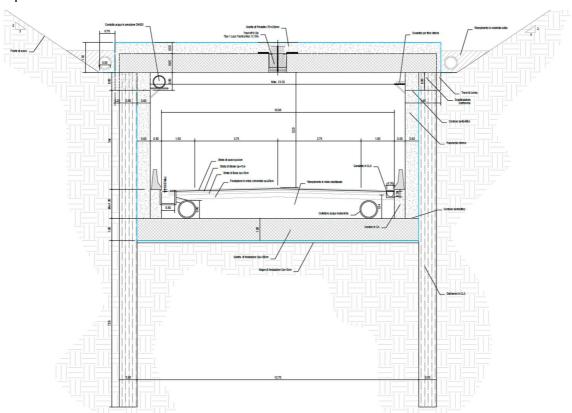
Scavo con diaframmi – sezione TIPO 1 (Galleria di linea)
